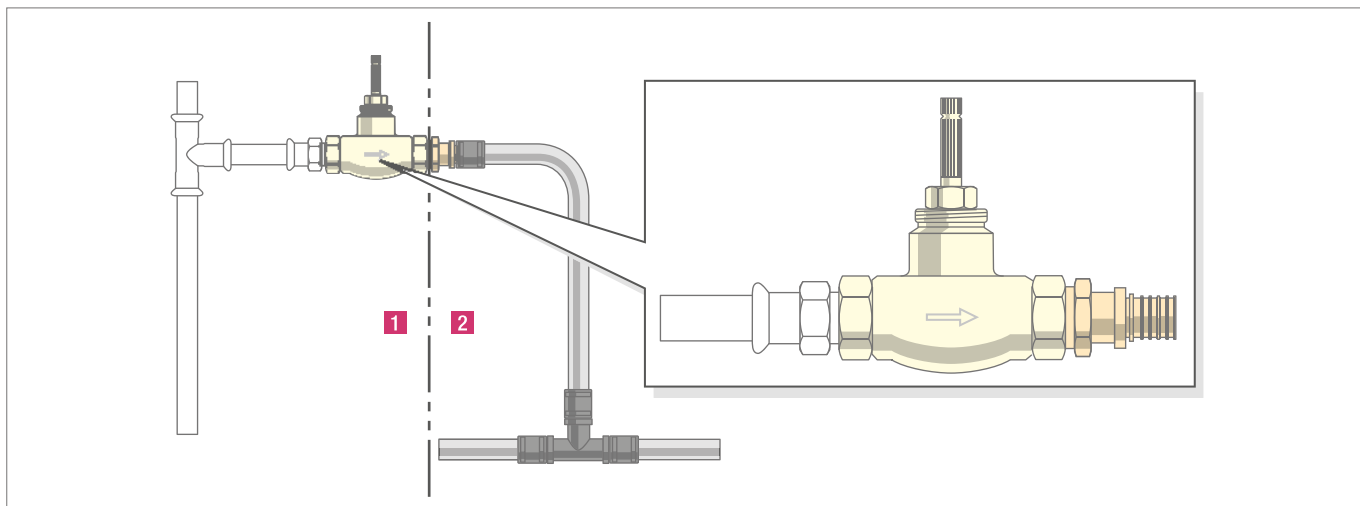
Монтажная ситуация Переходник системы трубопровода на клапане для скрытого монтажа (пример)
